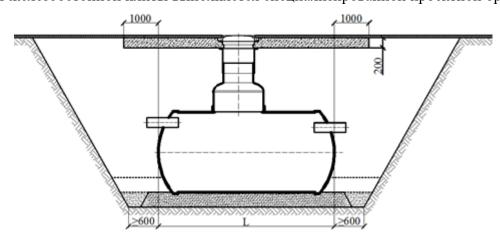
Схема расположения горизонтального корпуса в зоне наезда транспорта с низким уровнем грунтовых вод
